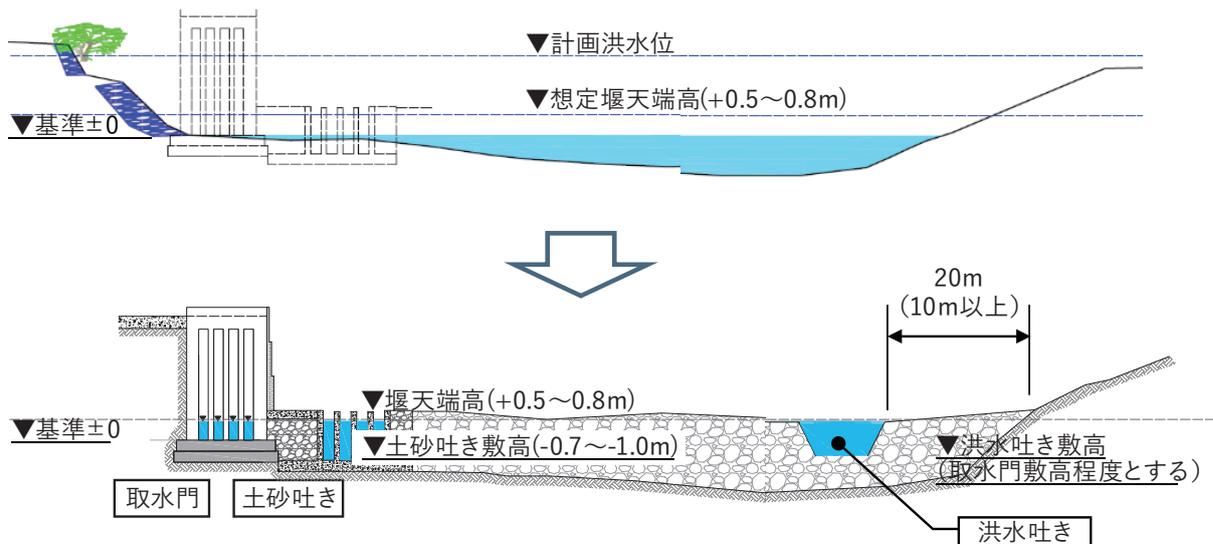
巨礫積み斜め堰の横断面図<sup>2)</sup>
